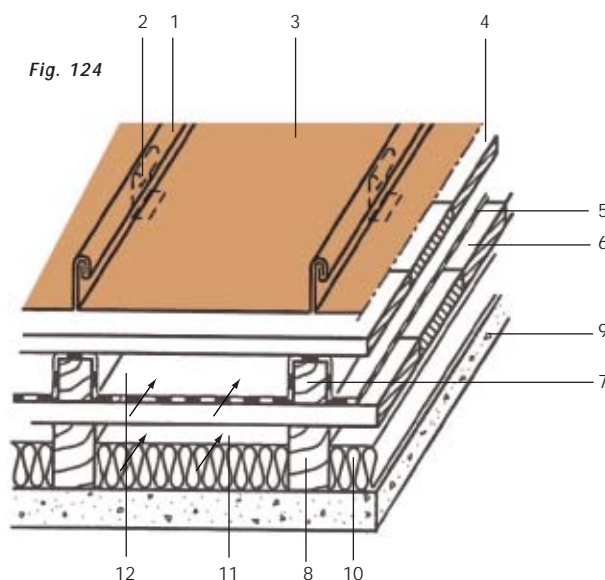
Junta elevada encaixada com isolamento térmico.
